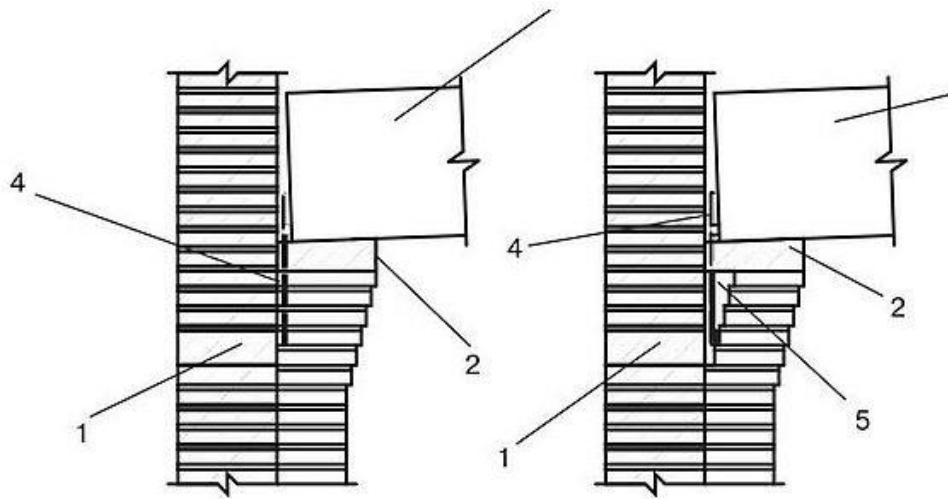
Опирание балки на кирпичную пиллярную: а – по проекту; б – в натуре. 1 – ж/б пояс; 2 – опорная подушка; 3 – балка; 4 – анкер; 5 – раствор
